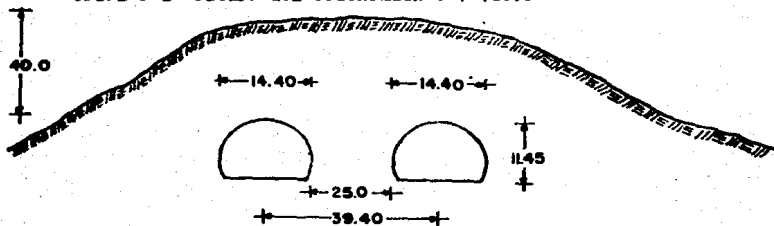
Corte esquemático en el cadenamiento 7+780
